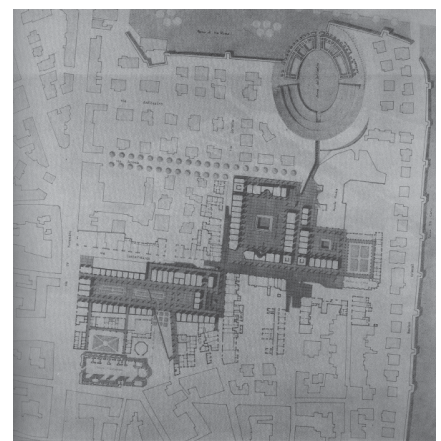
Planimetria generale del progetto di riqualificazione dell'area San Francesco.
